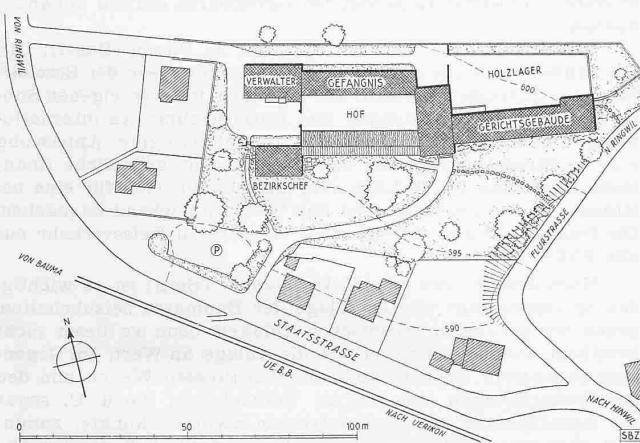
Bezirksgebäude Hinwil. — Lageplan Maßstab 1:2000
